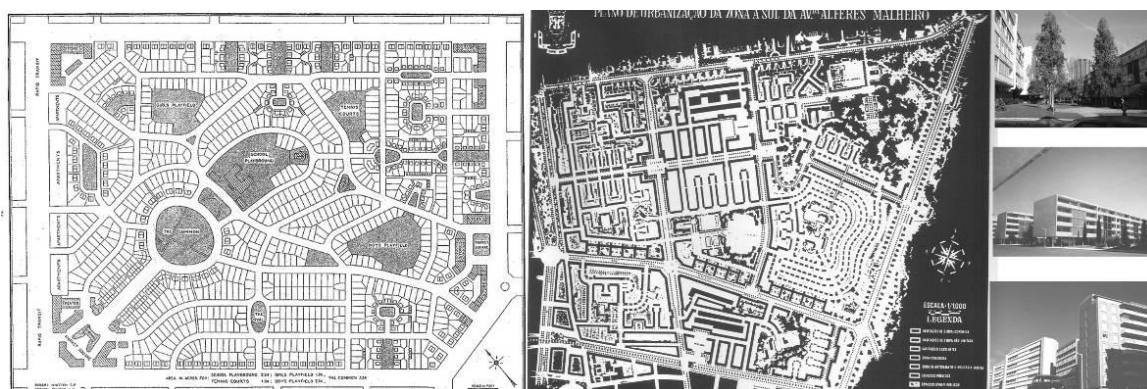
Plano e Imagens de Alvalade - Bairro das Estacas
